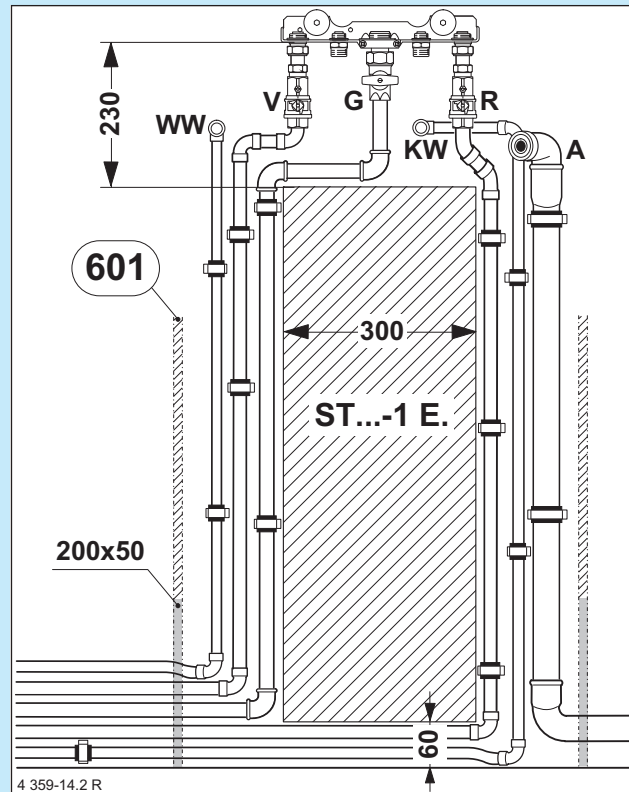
Bauseitige Aufputzverrohrung ohne Wandabstand
